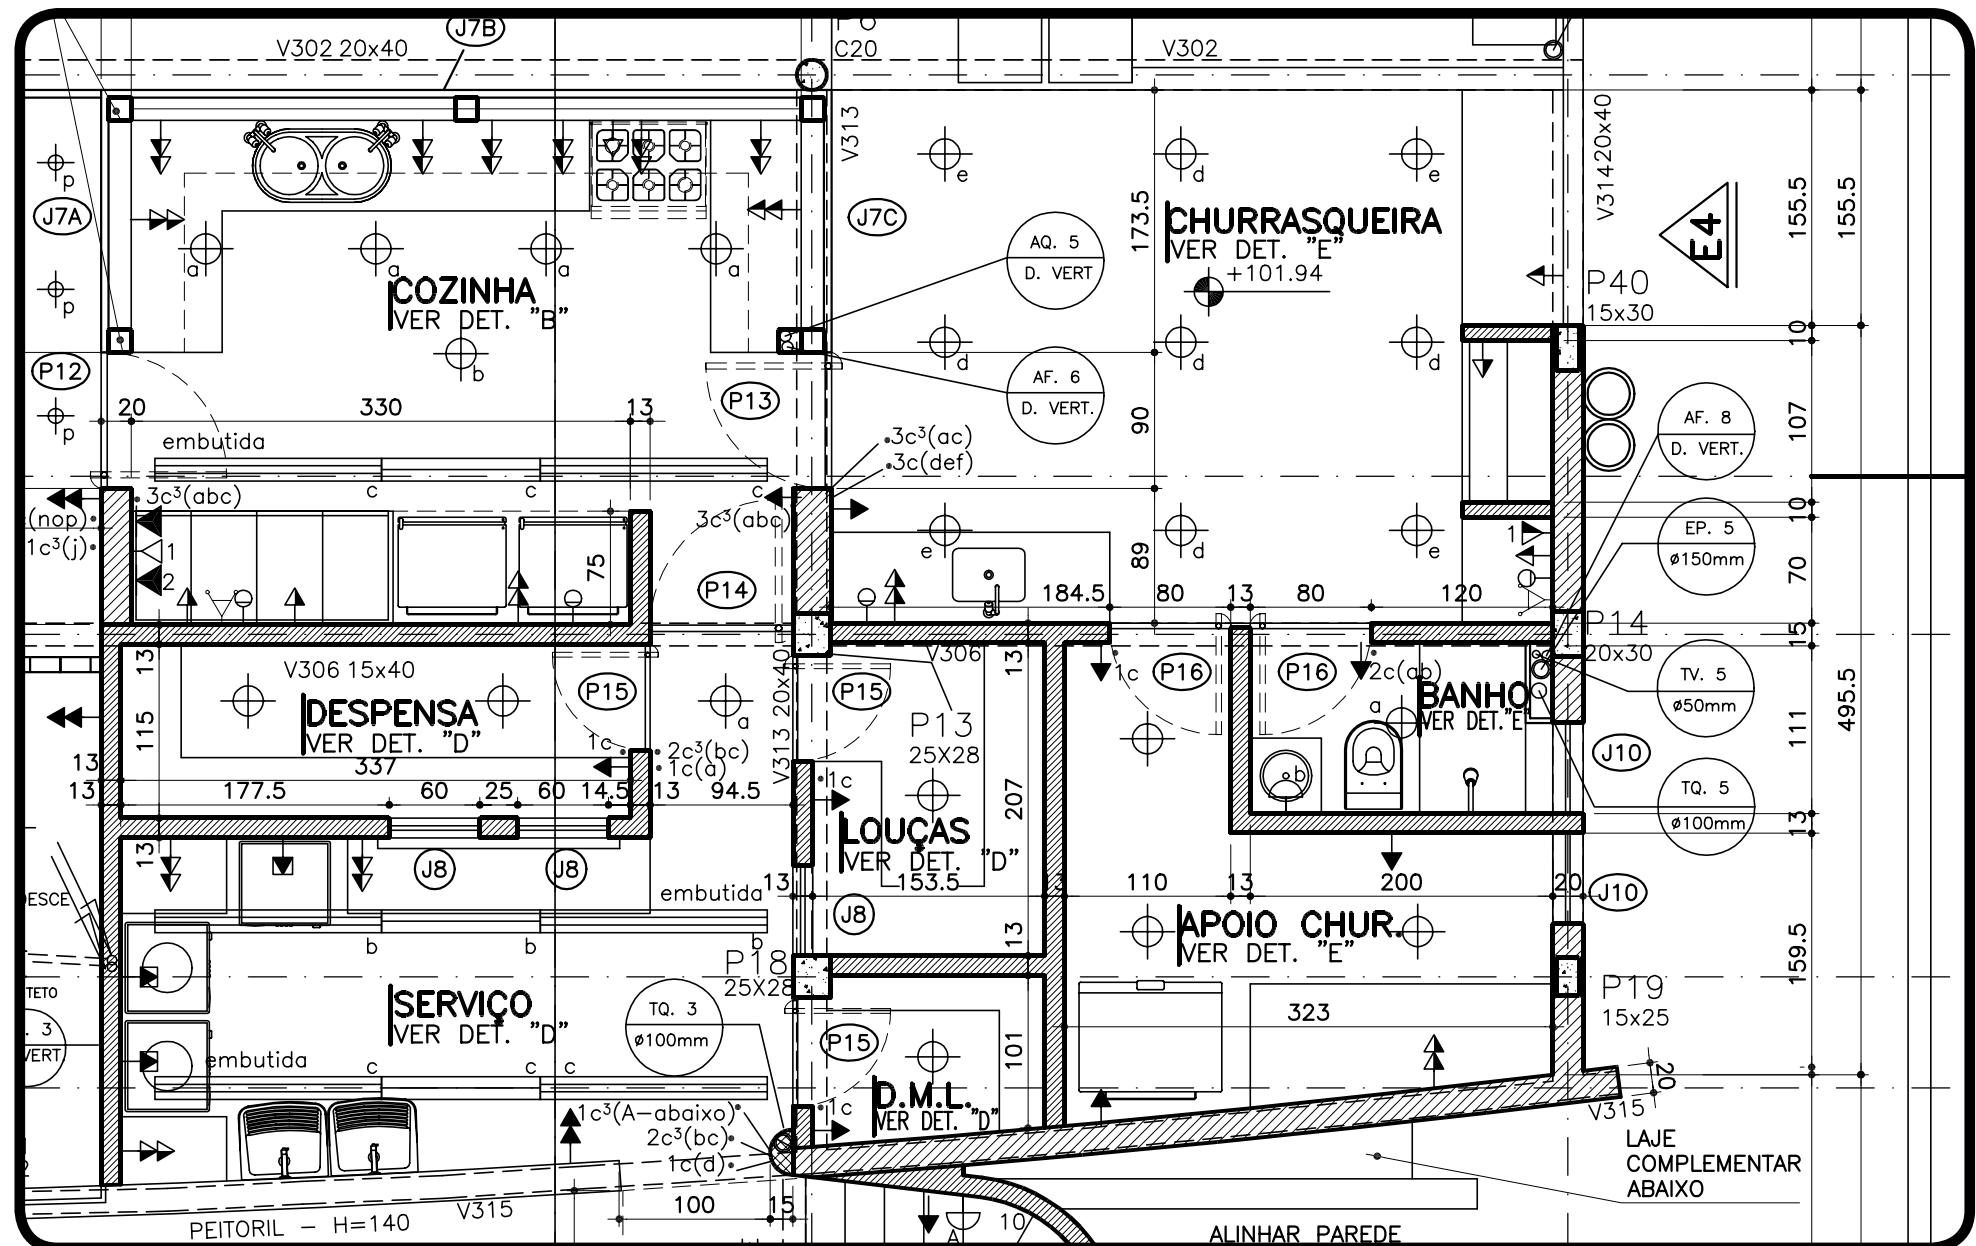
Pormenor da planta anterior em escala original (1:50)
